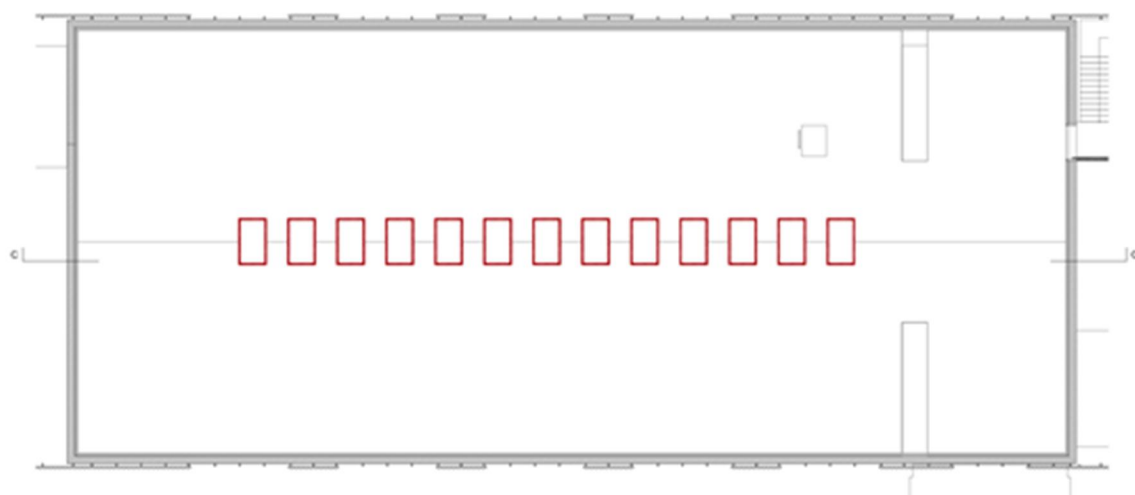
Planimetria della copertura con indicazione del posizionamento del trattamento acustico a lato dei lucernari_pianta
